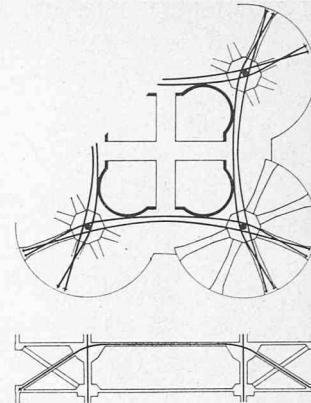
Technikgeschoss. Spannbewehrungsschema der Zugdiagonalen eines Grundrisskreises, die kein «Gegenüber» haben
